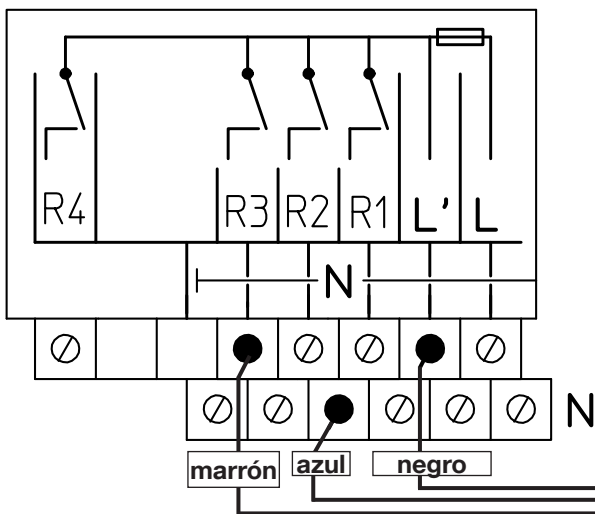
Cableado del actuador del dispositivo de corte y del controlador
